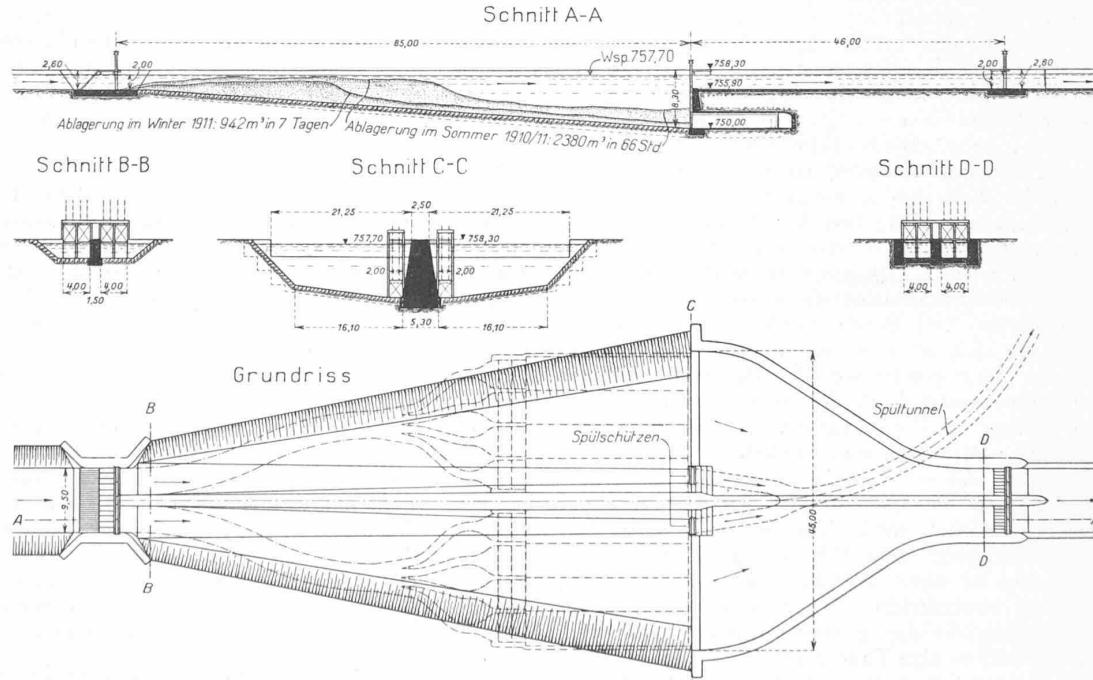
Ursprüngliches Sandabsatzbecken der Anlage Florida-Alta in Chile. — Grundriss und Schnitte 1:1000.
